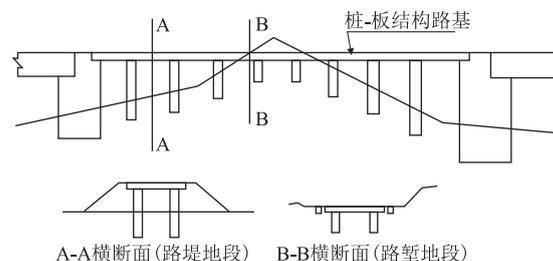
两桥(隧)之间设置钢筋混凝土桩板结构示意图
